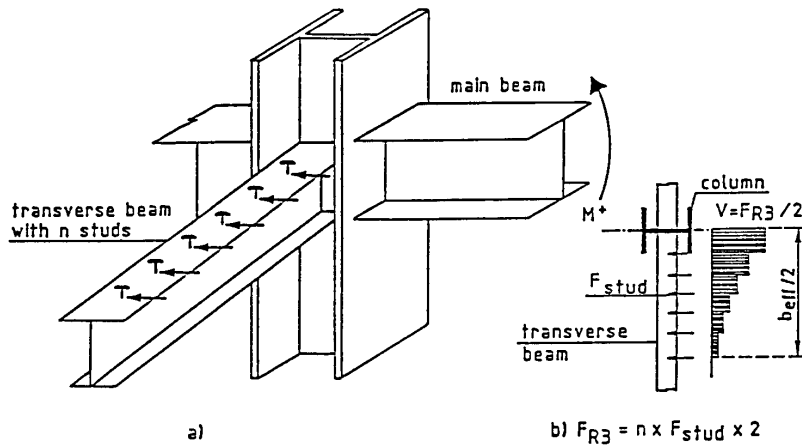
Transmission de la compression dans la dalle par la poutre transversale
